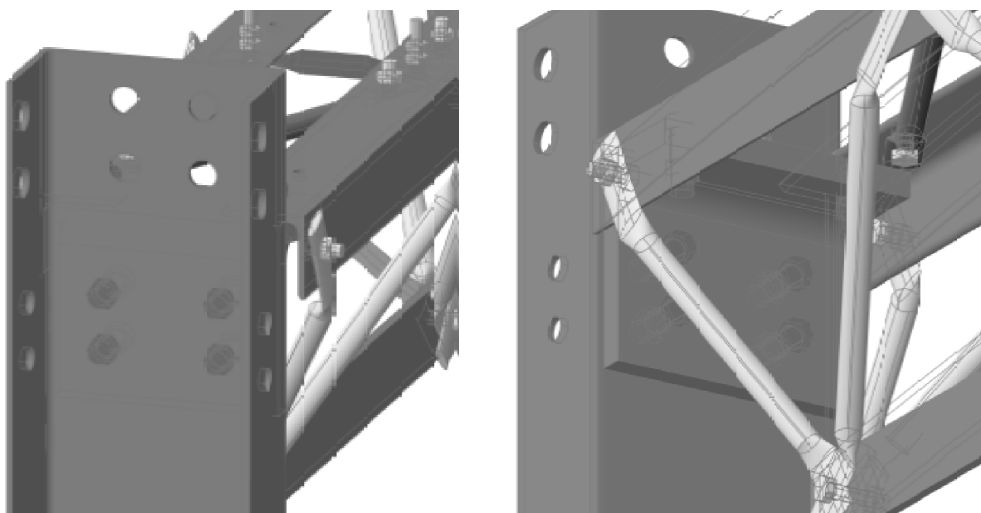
Pormenor 3d da ligação aparafusada treliça/pilar
